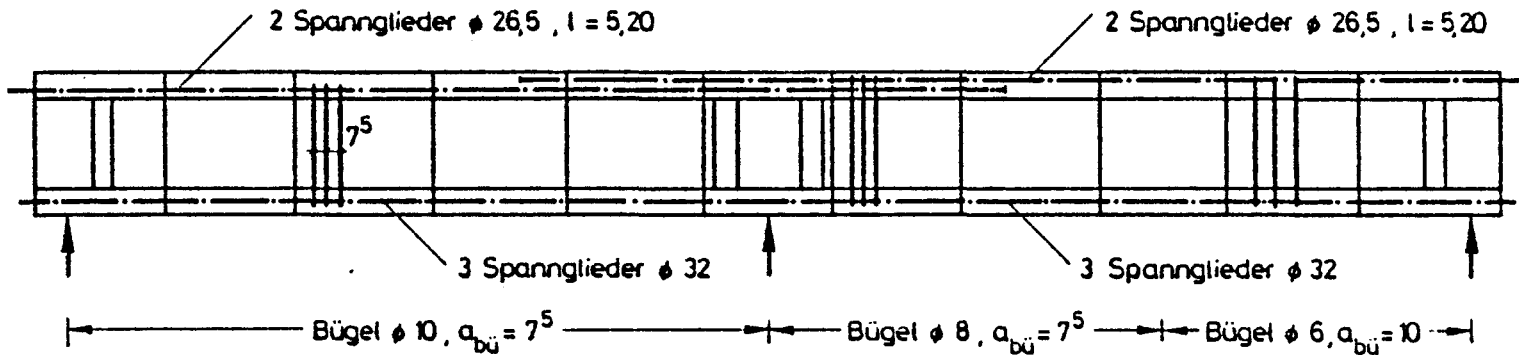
Anordnung der Betonstahl- und Spannstahlbewehrung
